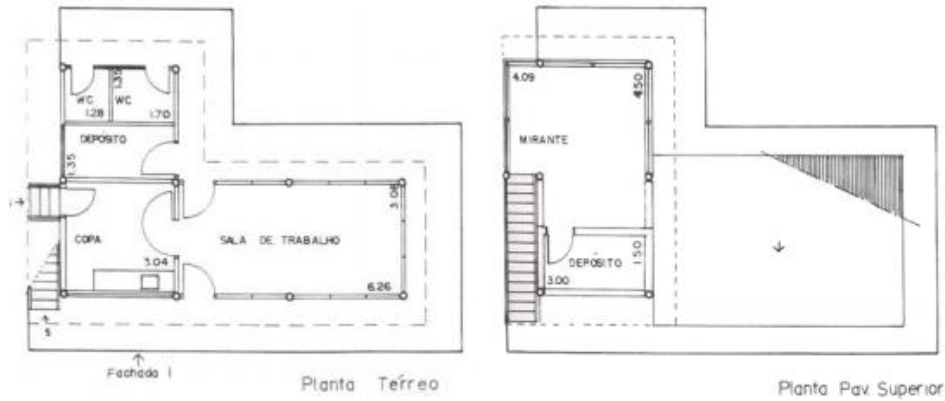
Planta baja 1 ° y 2 ° pavimento: proyecto de la Casa do Horto.
